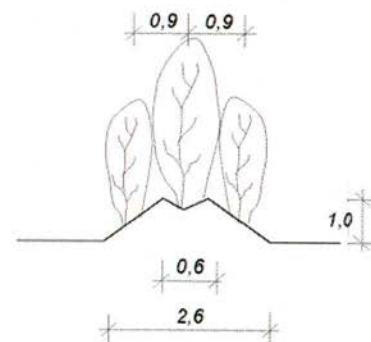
Aufbau einer Wallhecke (Querschnitt)
